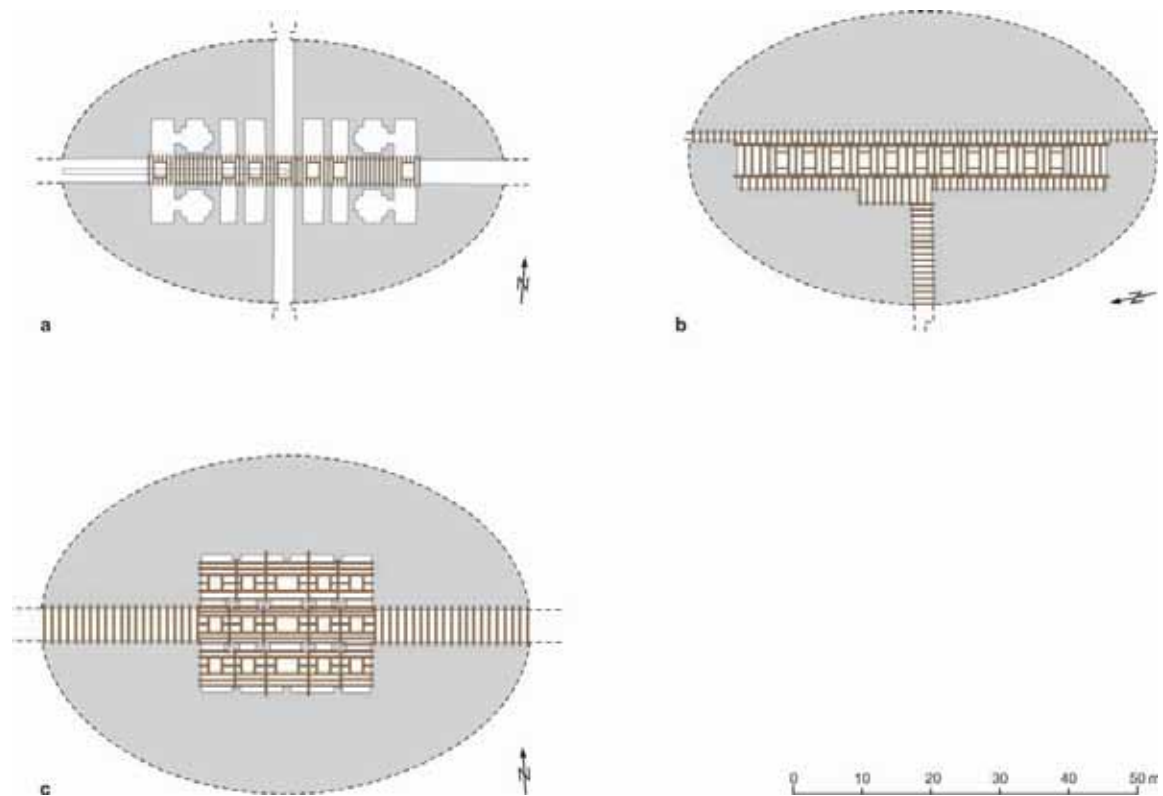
Beispiele für Amphitheater mit Untergeschossen (Grundrisse gesichert); Rekonstruktionsvorschläge für die Balkeneindeckungen der Gräben und Kammern. Zeichnung M. 1:1000.
